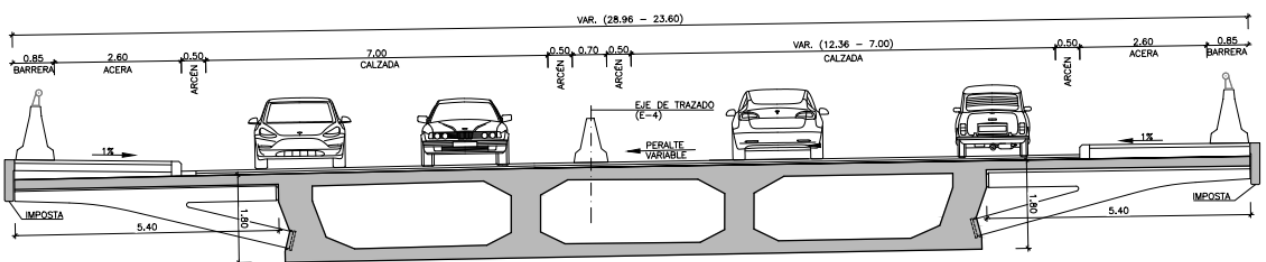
Sección transversal del viaducto en zona de ancho variable (cajón tricelular).
